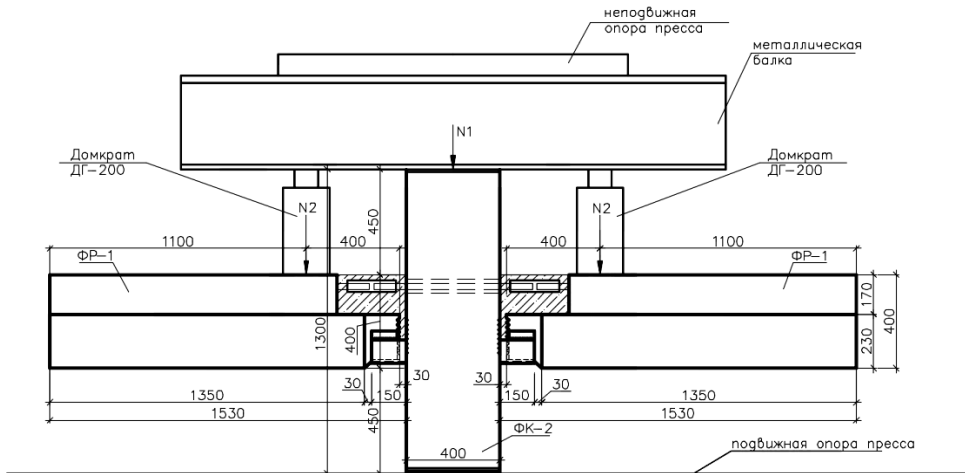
Схема испытания узла сопряжения ригелей с колонной по второй схеме (на действии поперечной силы)
